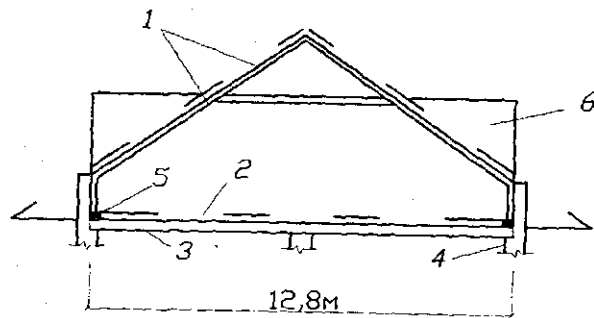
Поперечный разрез мансарды коттеджа в Советском районе г. Волгограда: 1 — рама пролетом 12,8 м; 2 — затяжка; 3 — плиты перекрытия; 4 — кирпичные стены; 5 — металлический пояс; 6 — люкарны
